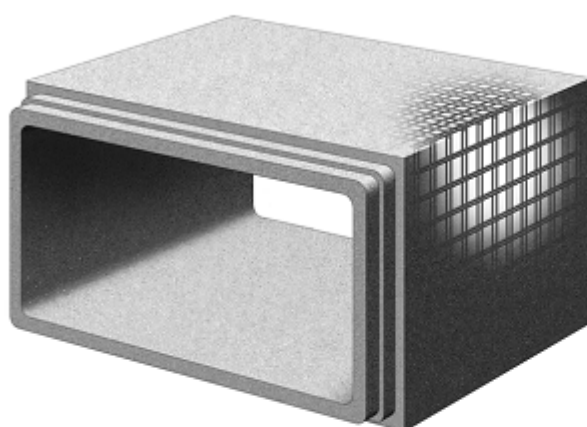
F : Scavo con rostro interno pozzo autoaffondante
